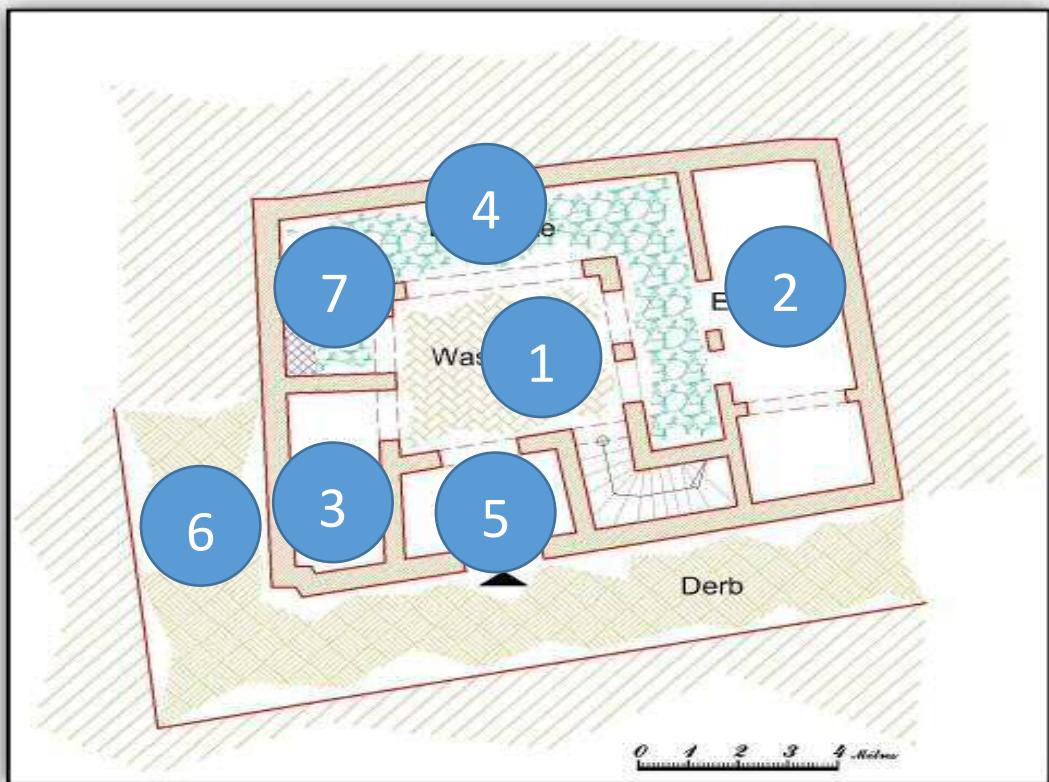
Plan du rez de chaussée de Dar Tchouar.
